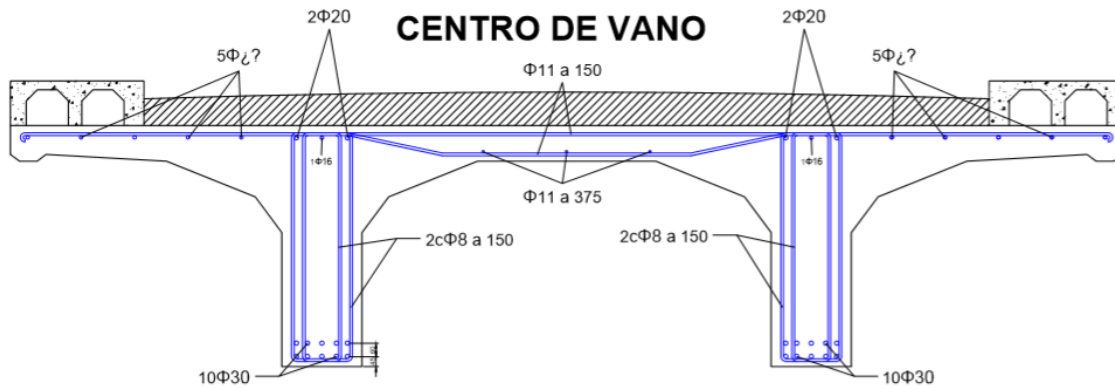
Detalle de armado de la pieza cortada en centro del vano
